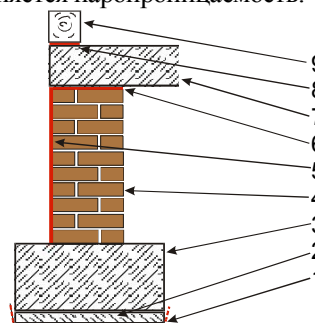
Гидроизоляция фундаментной стены на этапе строительства от влажности и влияния среды:
